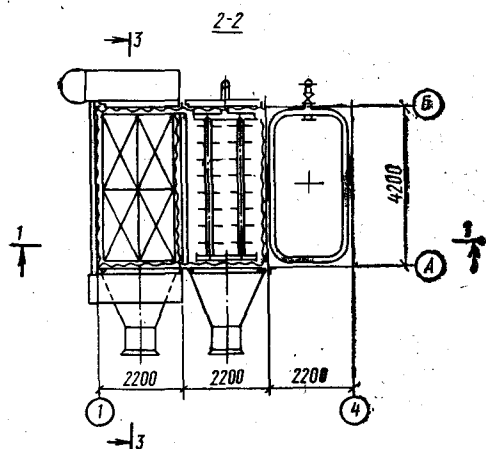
Градирия, размещаемая на кровле, с нижним расположением вентиляторов (конструкция Союзводоканалпроекта).
